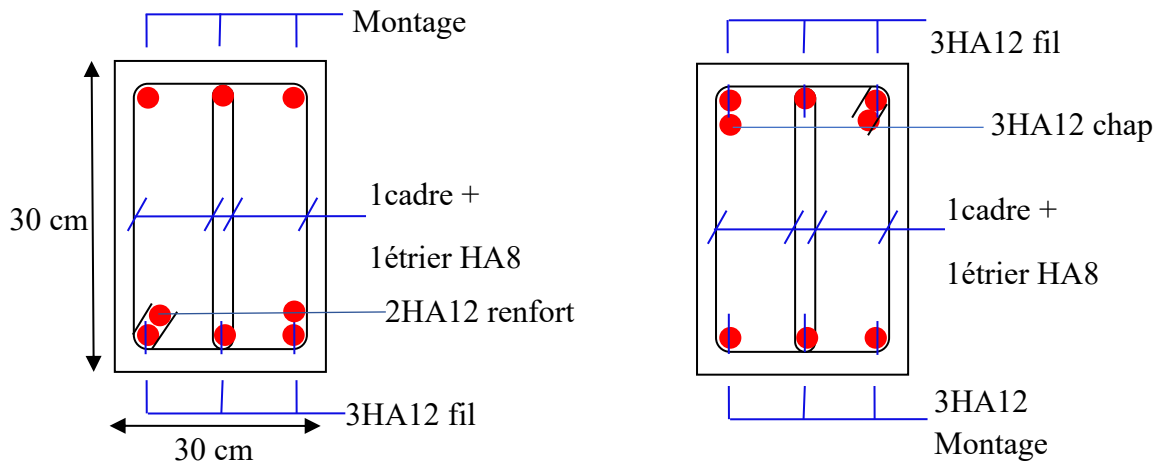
Ferrailage des poutres secondaires (30x30) en travée et en appui respectivement
